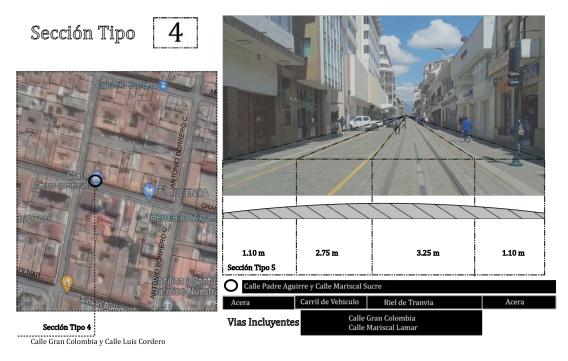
Sección vial tipo 4 de la zona de estudio. Fuente: Autor.
